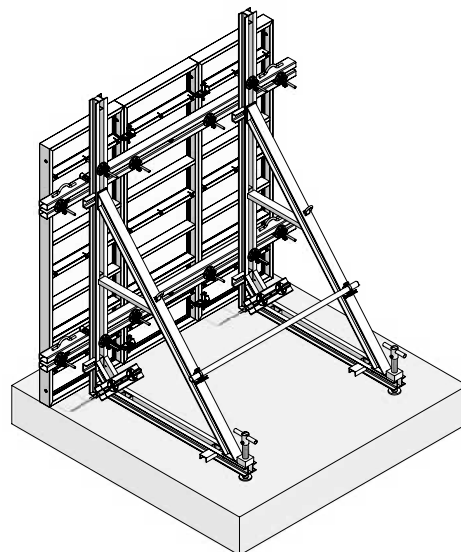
Stützbock STB 300 mit stehender Schalung
